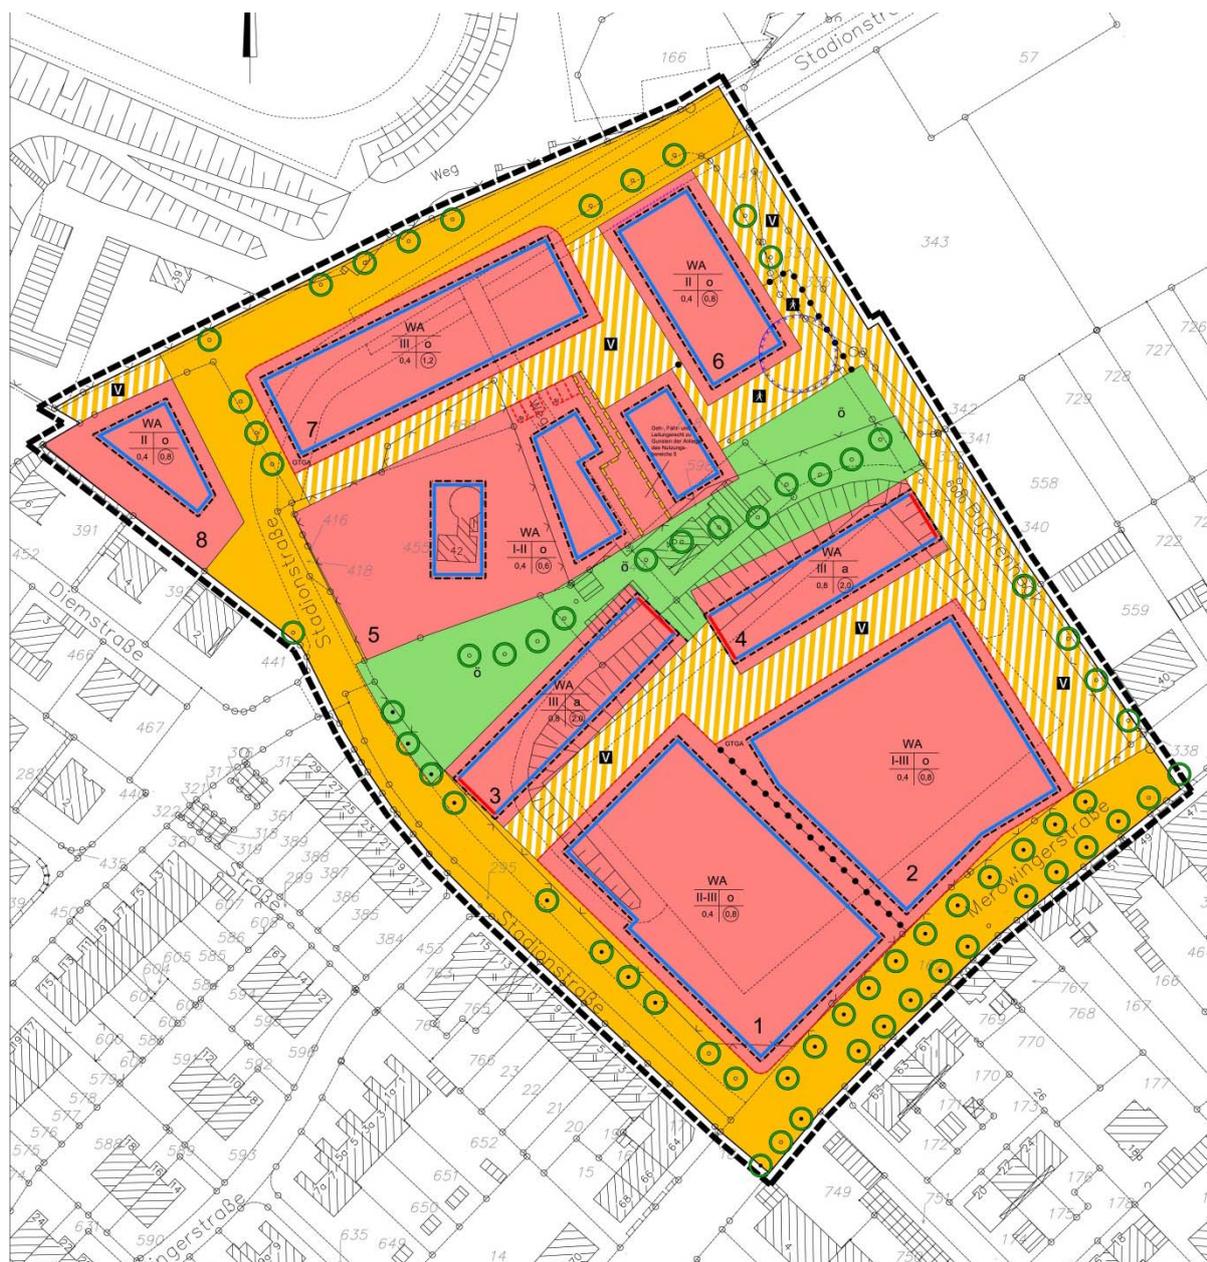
Auszug aus dem Bebauungsplan 1-053-1, unmaßstäblich
